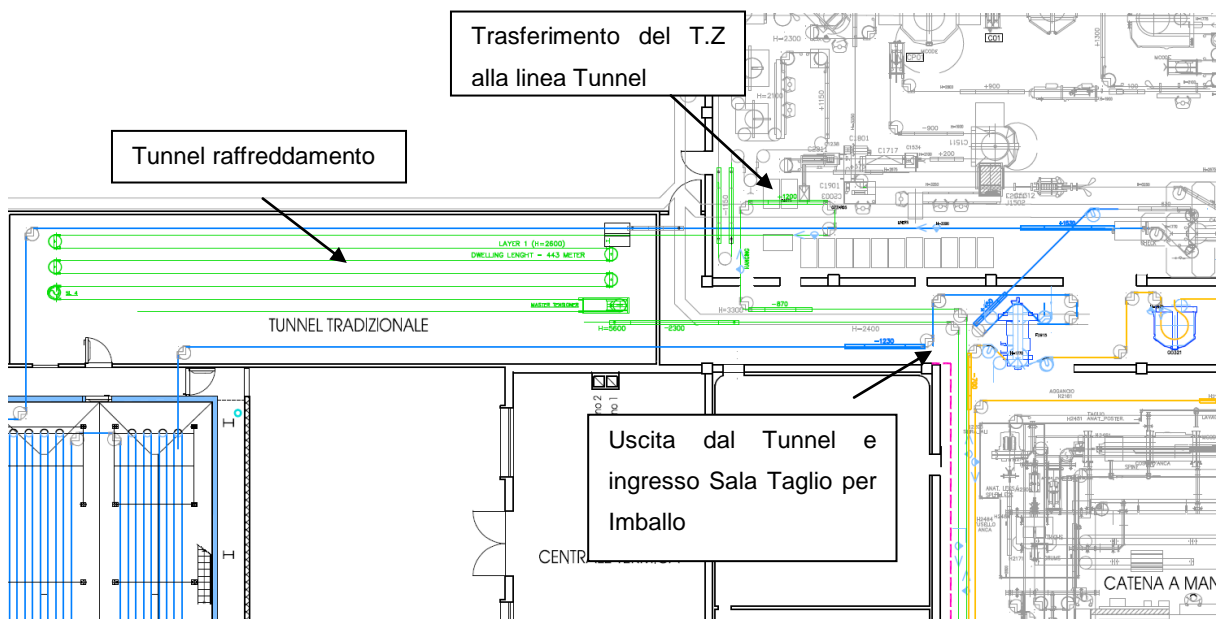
Schema impiantistico linea di macellazione e collegamento con il tunnel di raffreddamento
